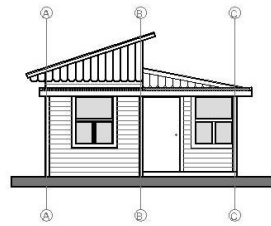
Vivienda María Elena Fallas. Elevación. Montes de Oca, San José.
